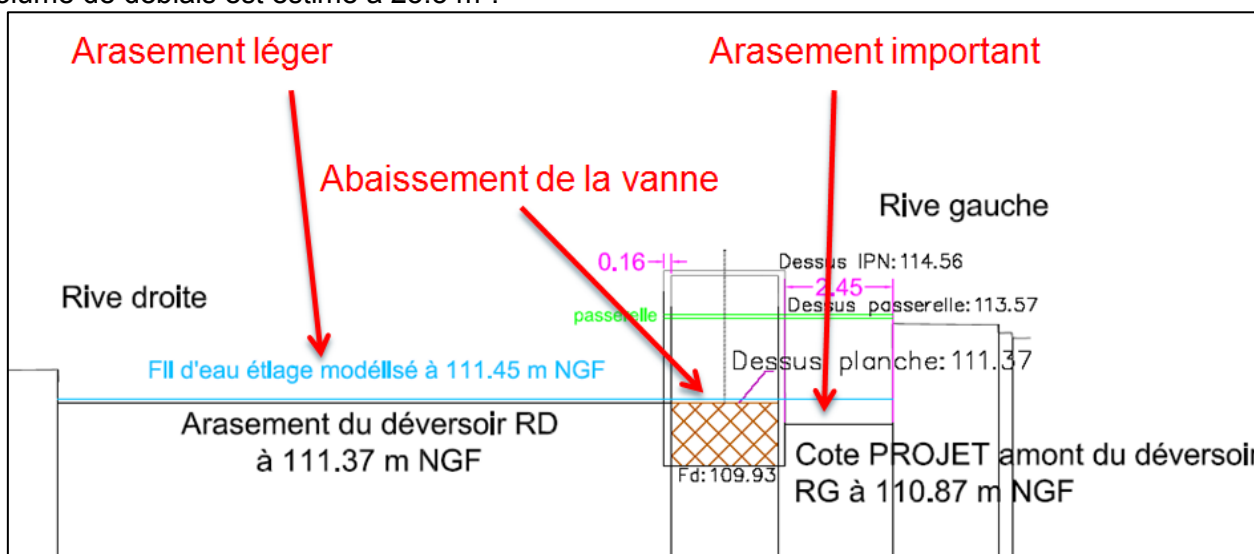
Coupe transversale de l'ouvrage de décharge, PROJET
